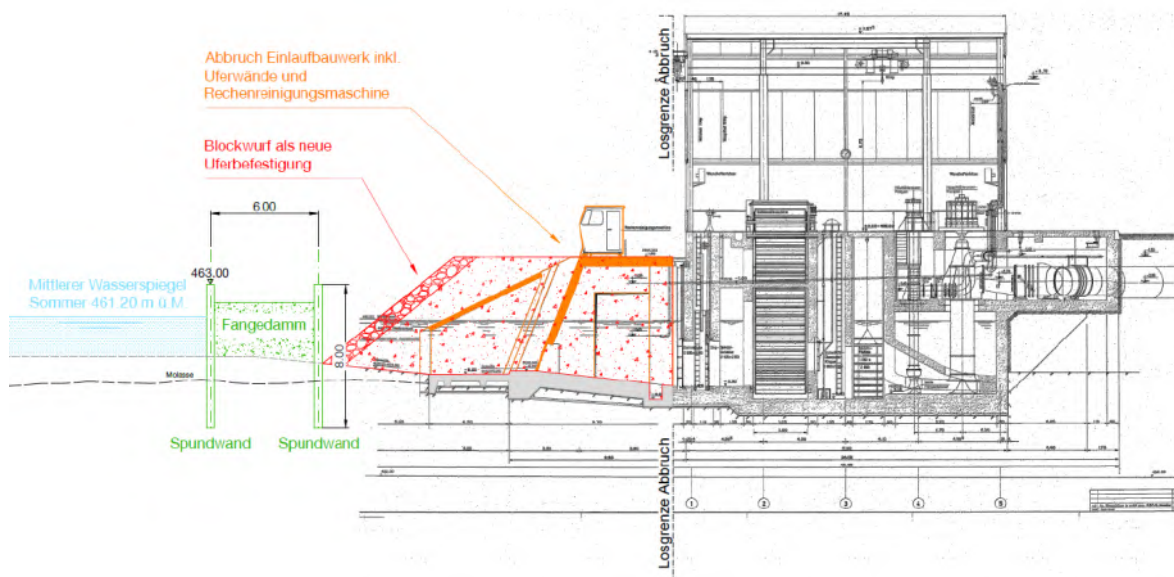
Querschnitt Rückbau Einlaufbauwerk
